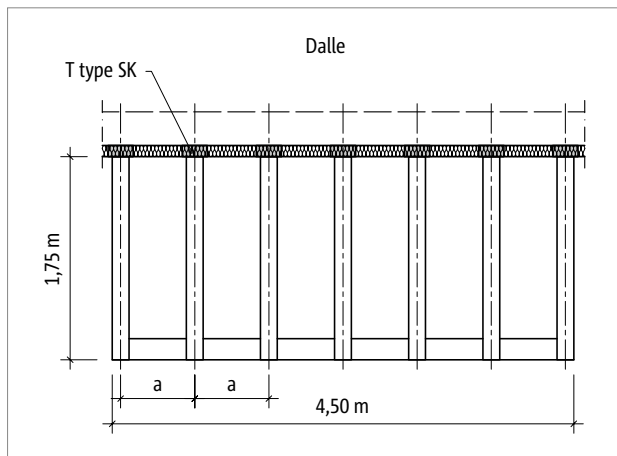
Schöck Isokorb® T type SK : vue en plan
